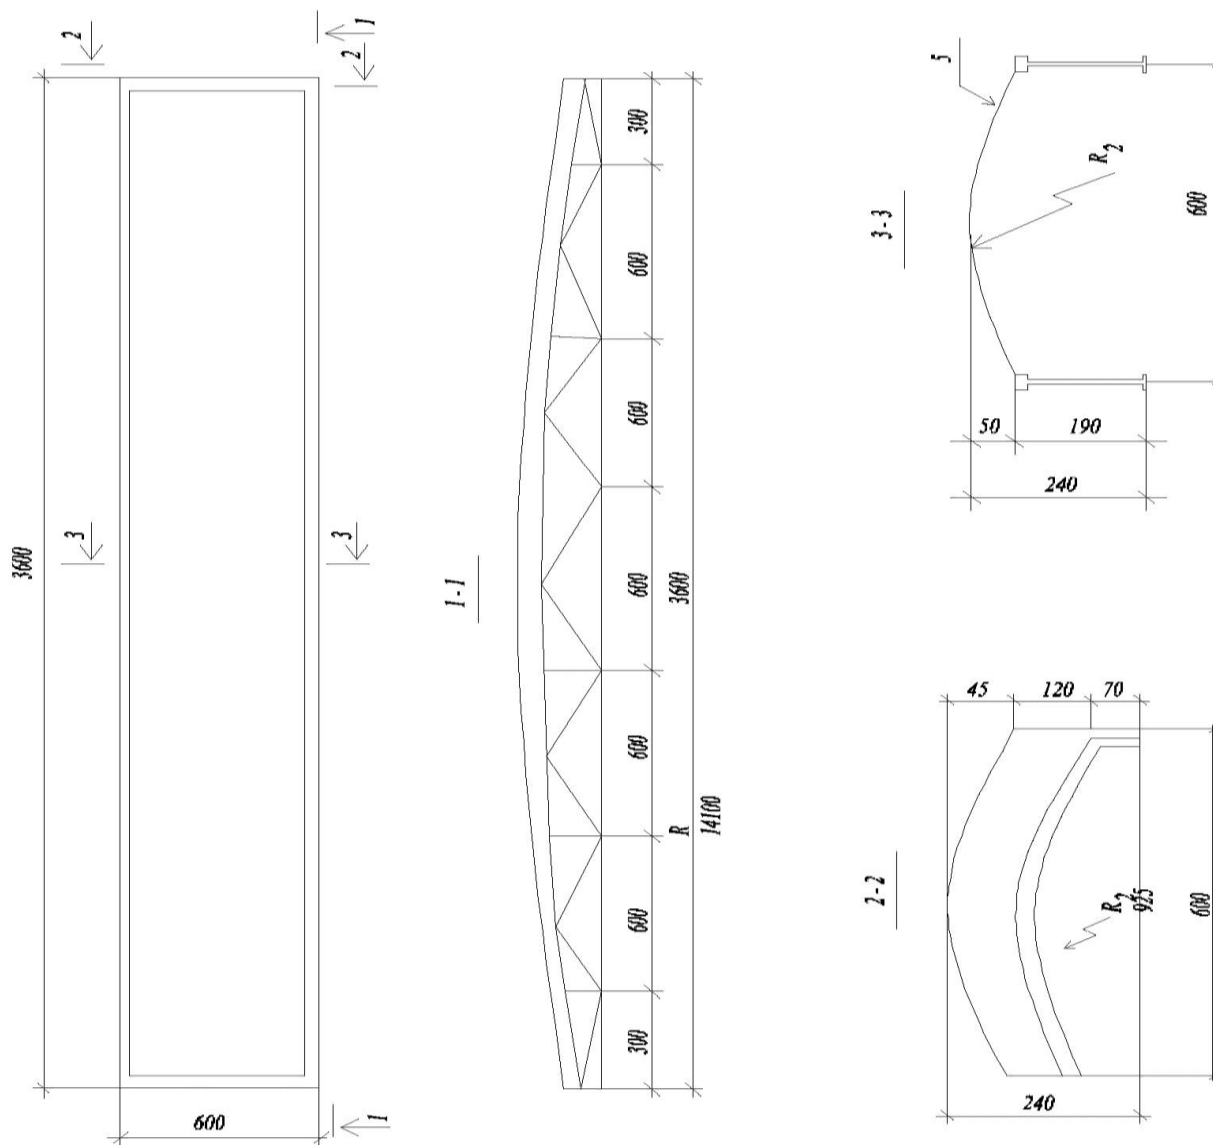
Конструкция модели армоцементно – стальной панели – оболочки размерами в плане 600 x 3600 мм.
